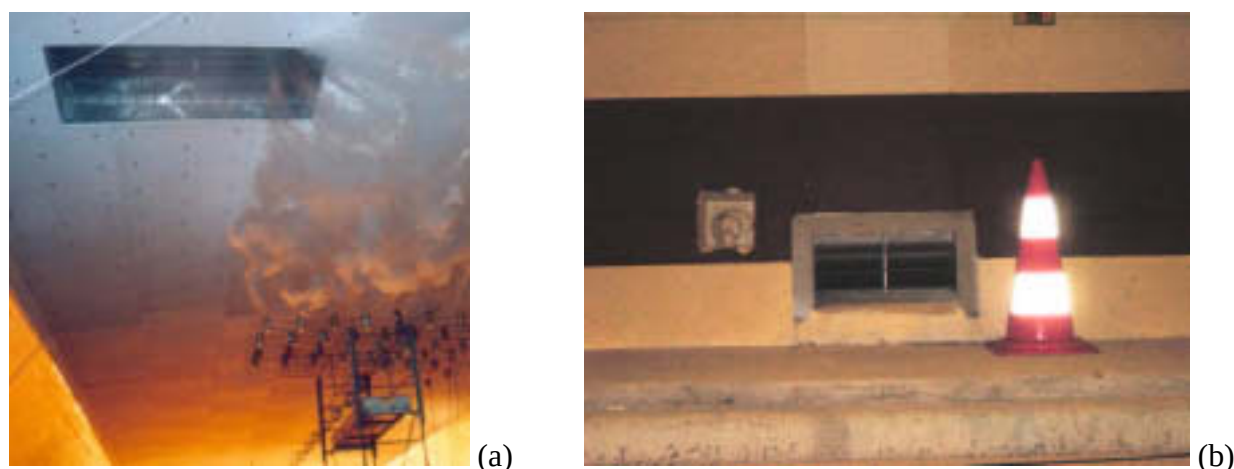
(a) Photo d'une trappe de désenfumage télécommandée ; (b) photo d'une bouche d'insufflation d'air frais.
